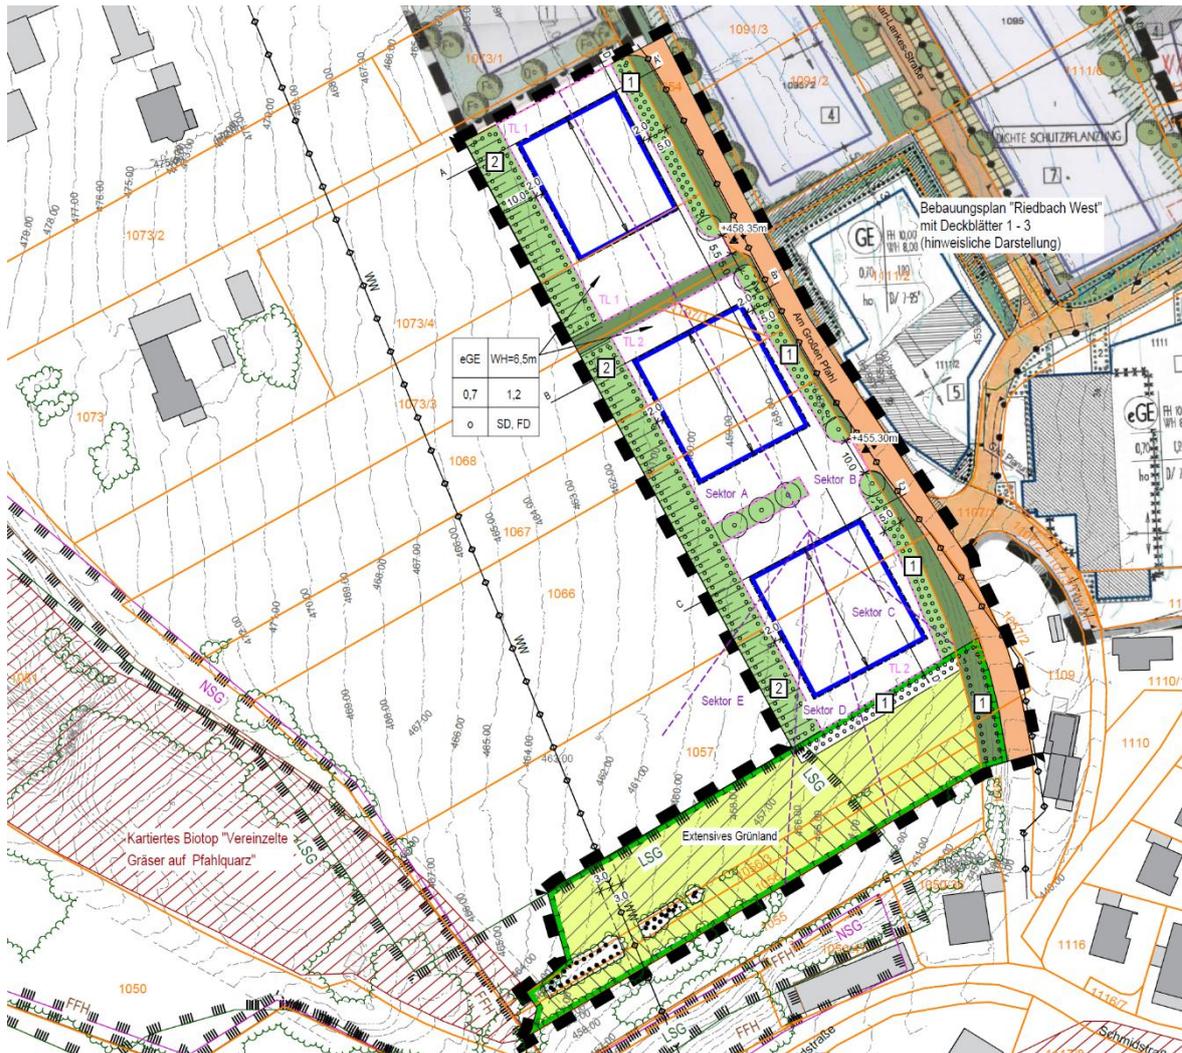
Vorentwurf zum Deckblatt 4 zum Bebauungsplan „Riedbach West“, Brunner Architekten
